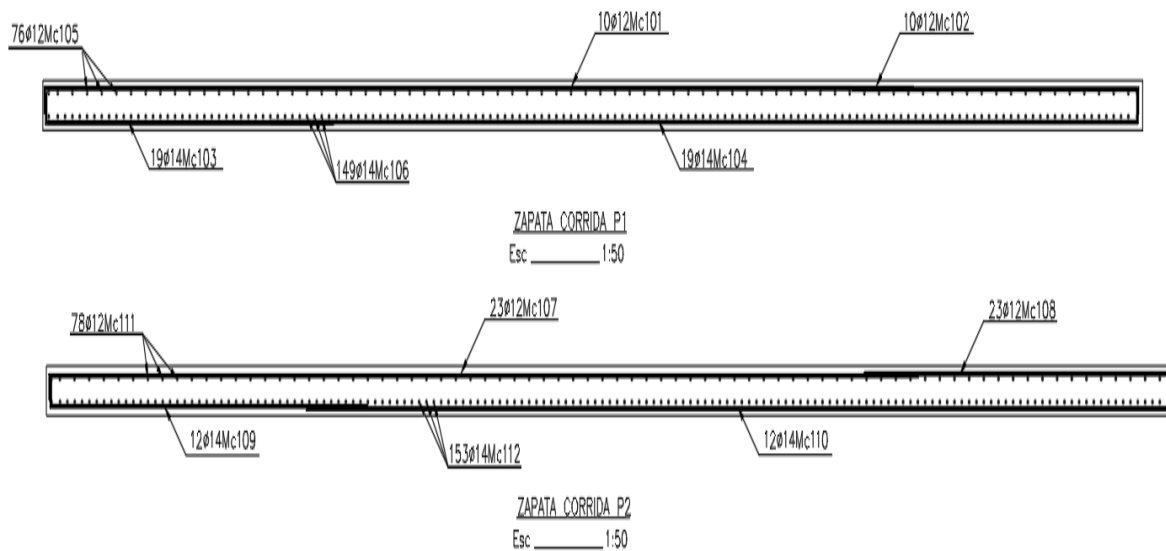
Detalle de refuerzo longitudinal en zapatas corridas tipo P1 y P2
